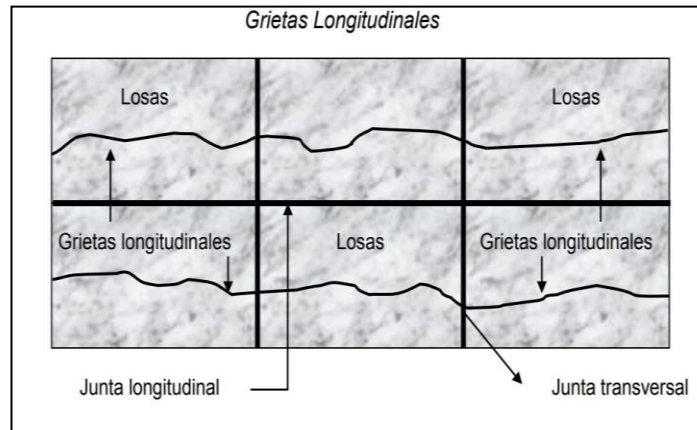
Falla por fisura longitudinal de Pavimento Rígido
